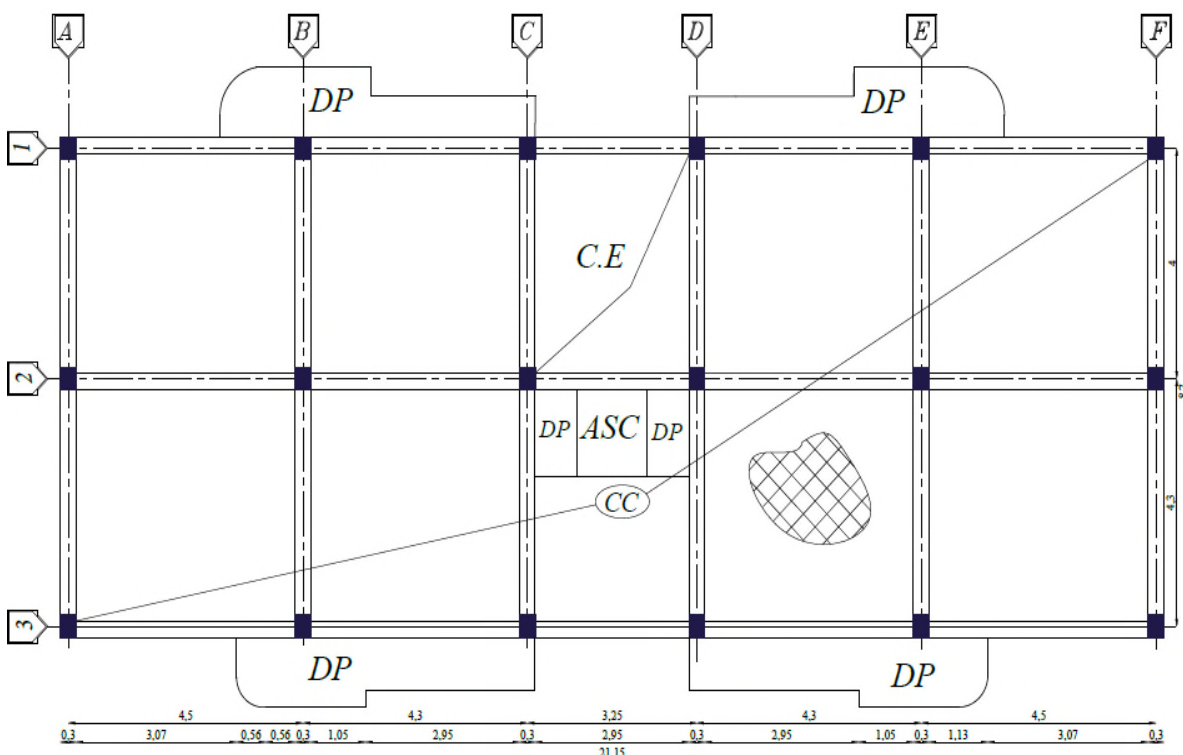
plans de coffrage du plancher étage courant (corps creux- dalle pleine)
